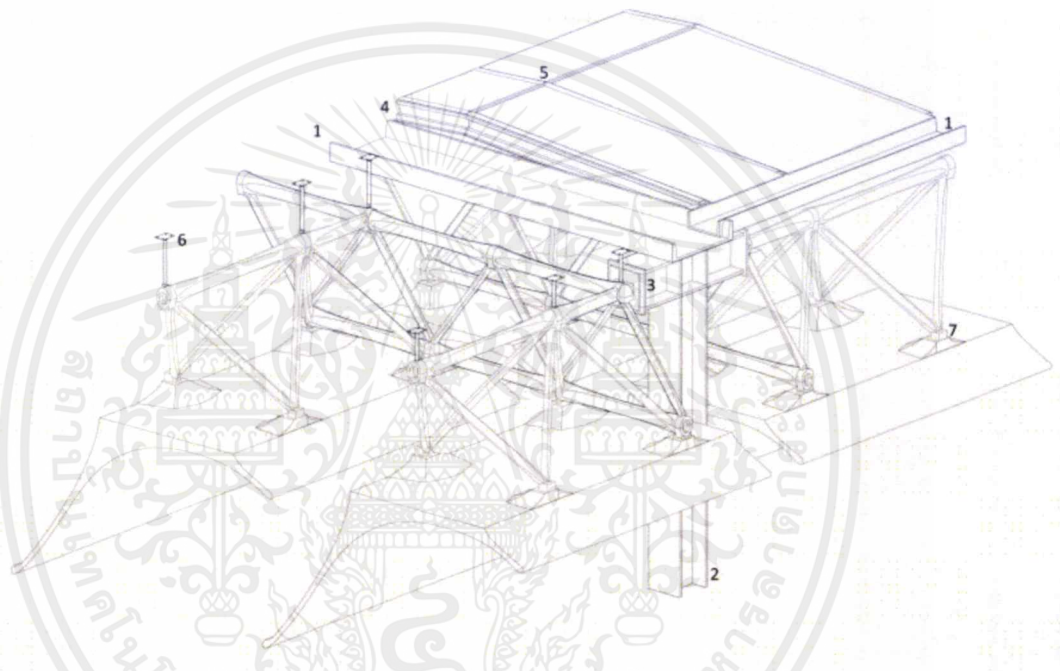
แสดง Wall section and Details ของโครงการ The Menil Collection
